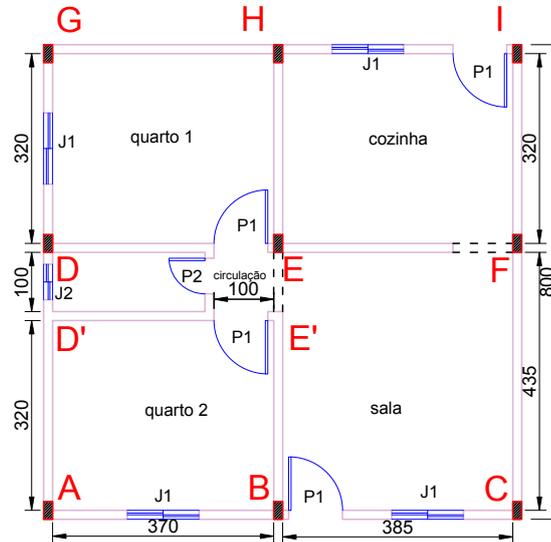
Planta baixa da casa ilustrada na Figura 12.
